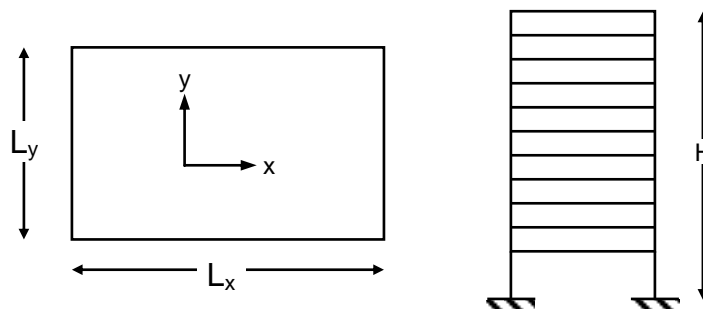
Esquema em planta e em elevação – parâmetros geométricos
